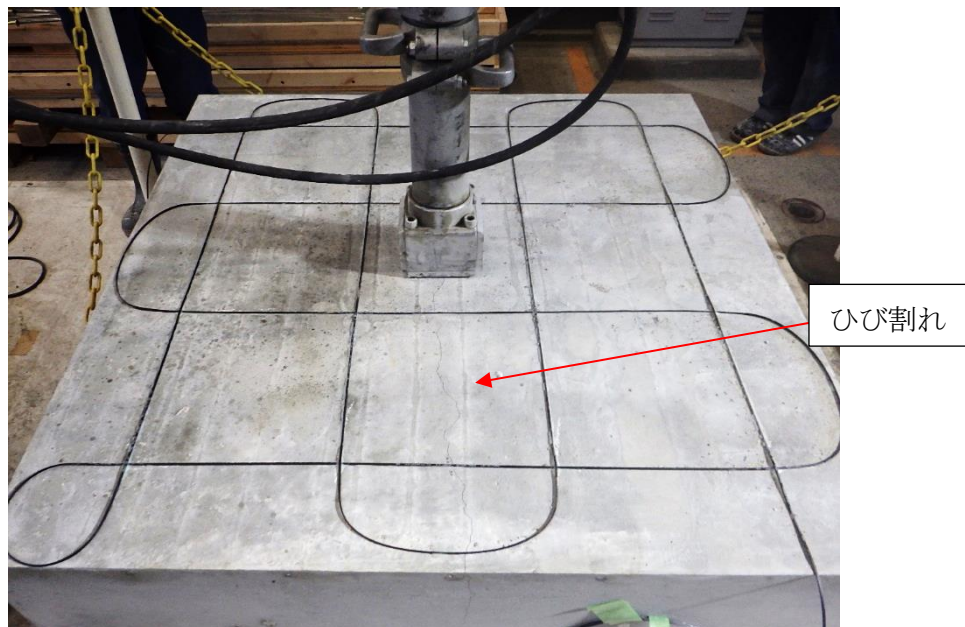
無筋コンクリート (光ファイバセンサー設置) ひび割れ発生状況
